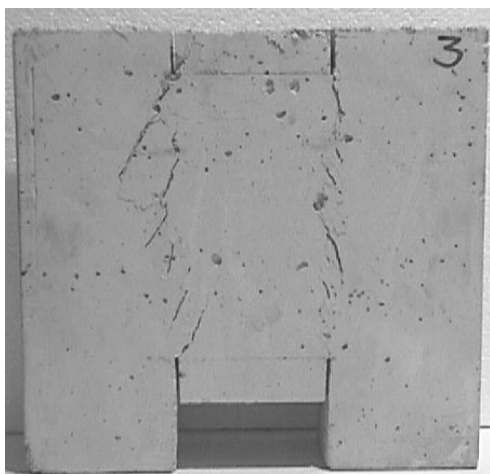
Probeta Monolítica-Sana con fisuras paralelas a lo largo del plano de corte, con una orientación a 60° con la horizontal.
